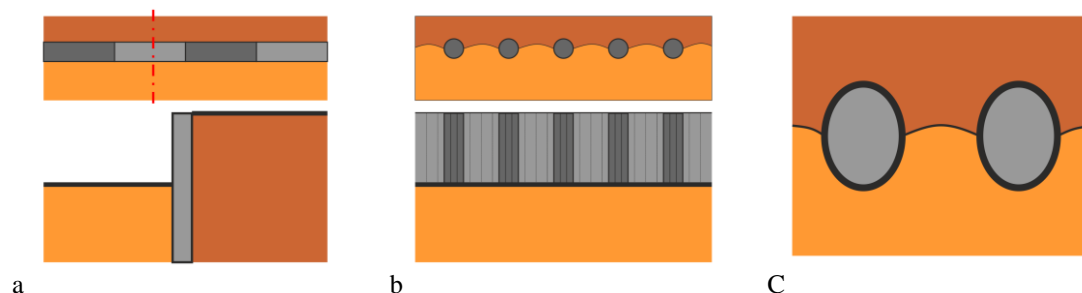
Unterschiedliche Typen von Stützbauwerken, (a) Grundriss und Schnitt Schlitzwand, (b) aufgelöste Pfahlwand, (c) Grundriss Brunnenwand
